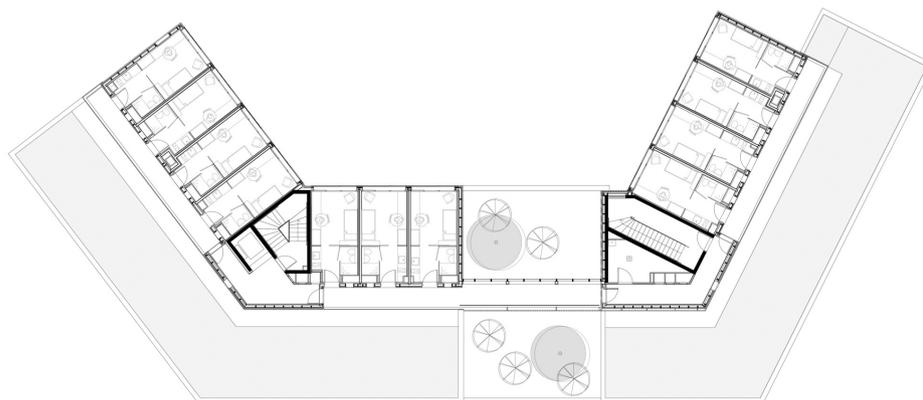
Lucien Cornil Student Residence, planta piso 5.
